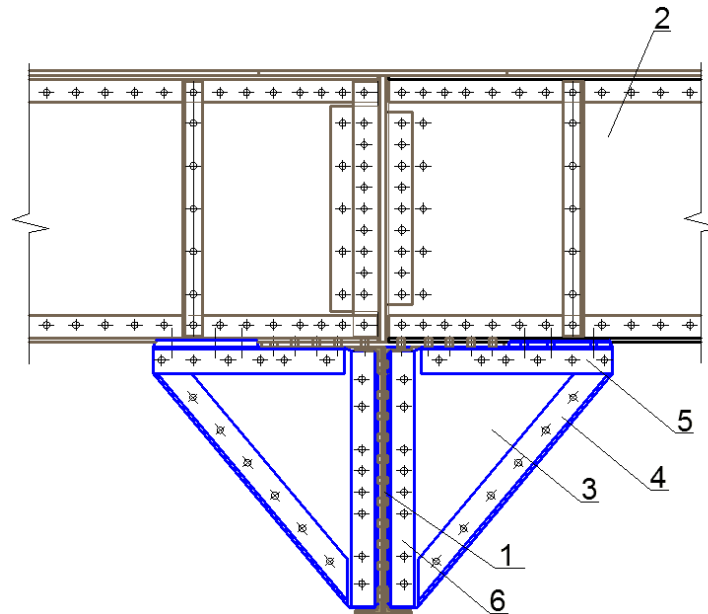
Вузол спирання поздовжньої балки на поперечну:
